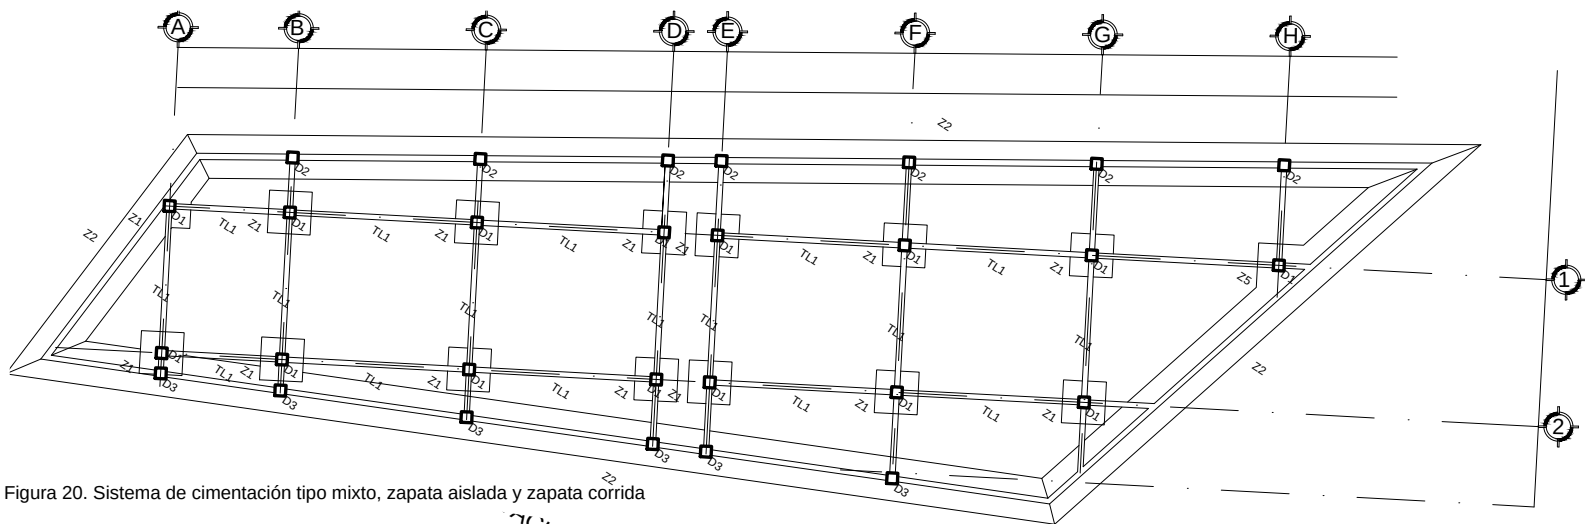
Sistema de cimentación tipo mixto, zapata aislada y zapata corrida
